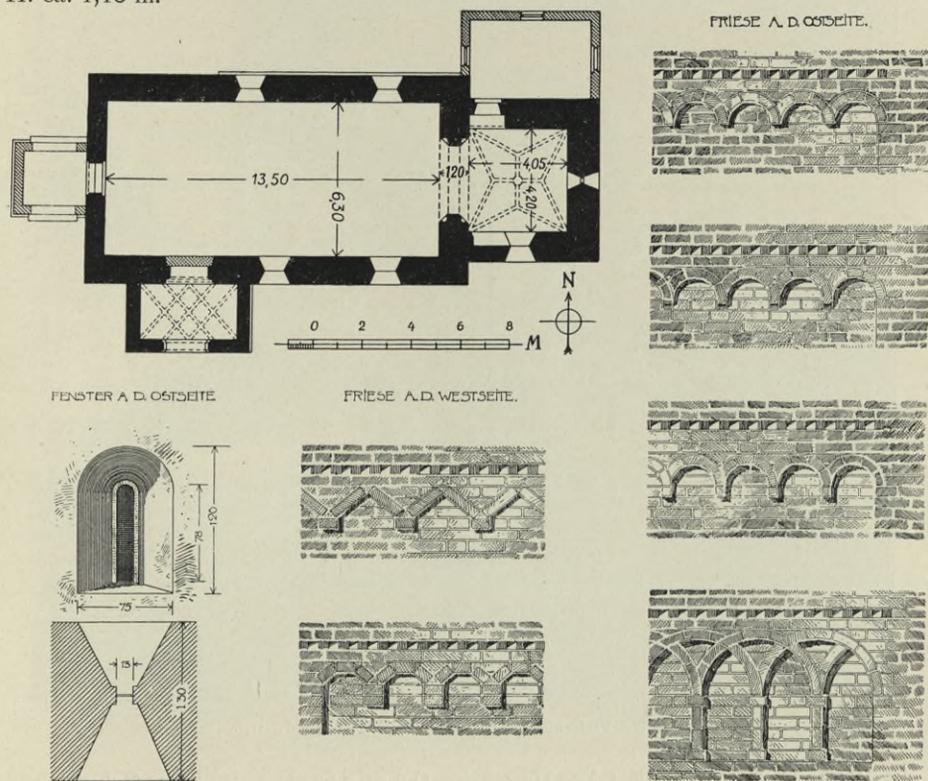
Preisenberg, Kirche. Grundriß und Details.
